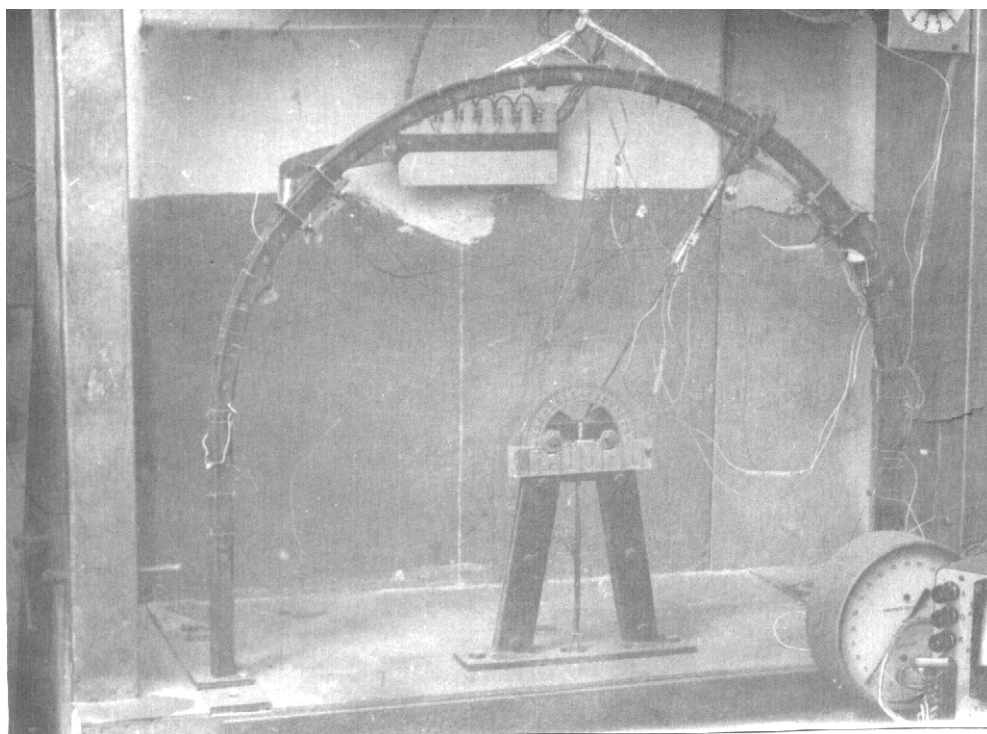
Общий вид стенда для испытаний моделей арочной крепи
